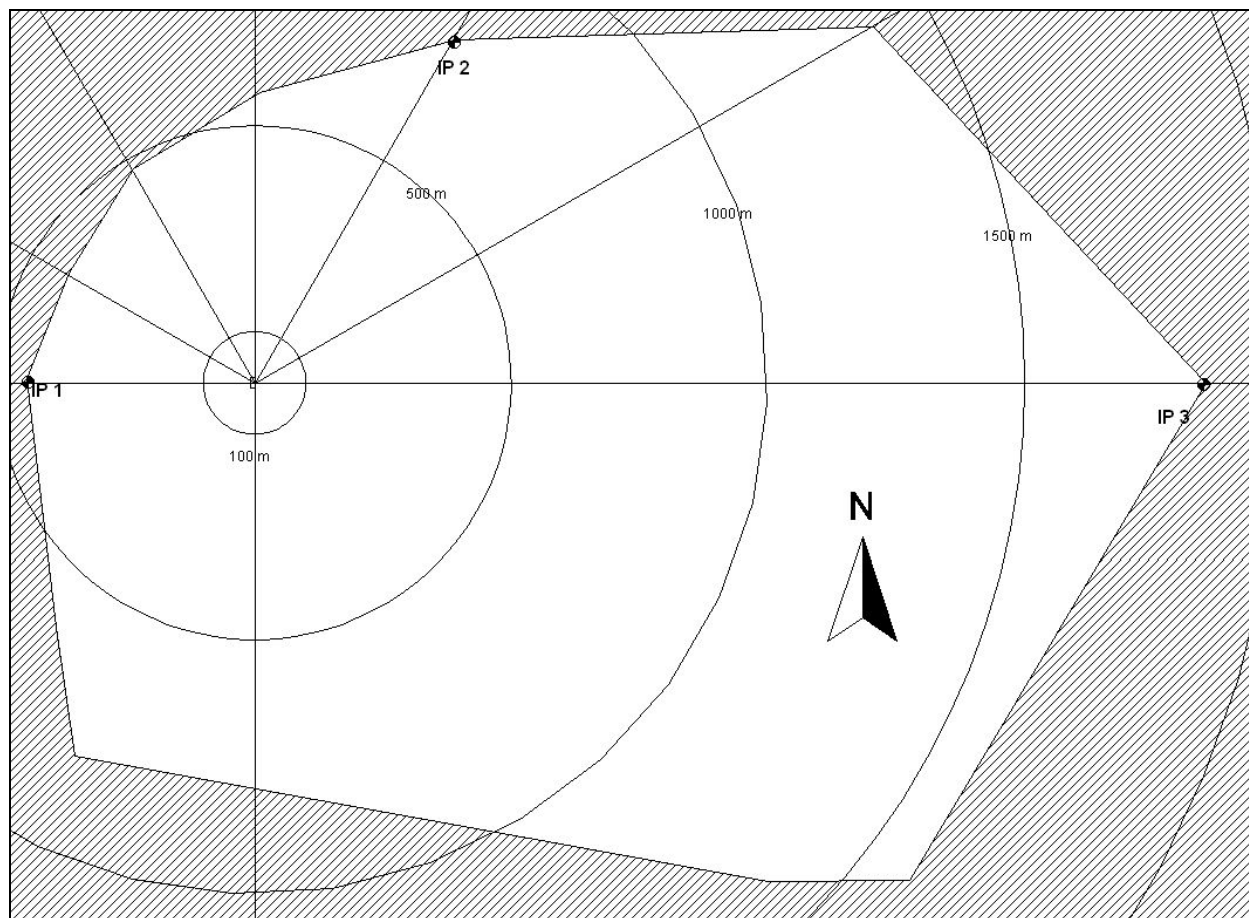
Lageplan mit Bauflächen und den Immissionsorten IP 1 - IP 3
